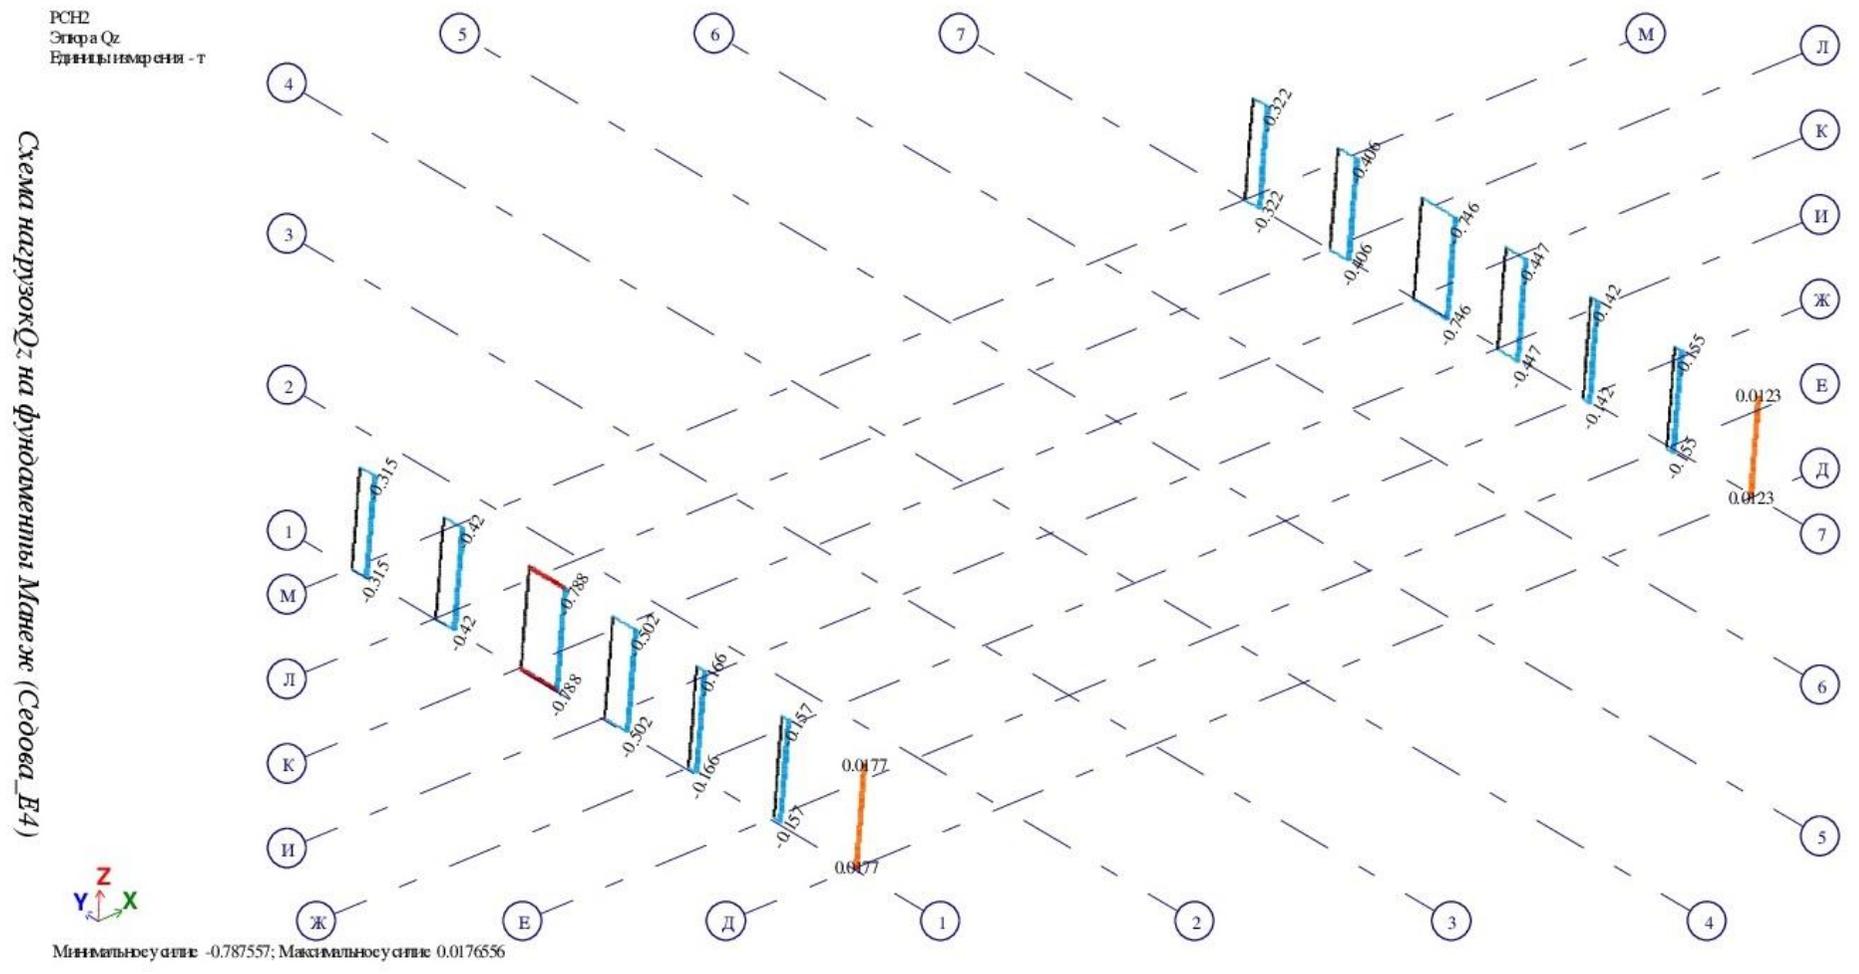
Схема нагрузок Qz на фундаменты манеж
